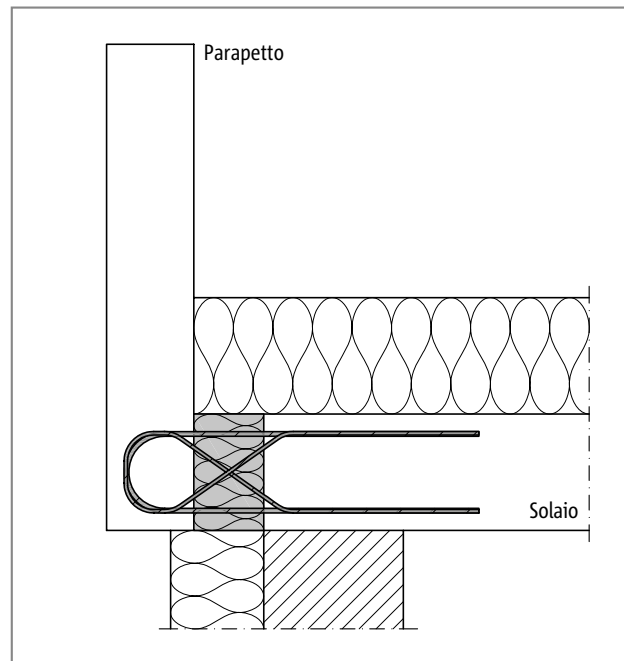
Schöck Isokorb® tipo ABXT - disposizione orizzontale, parapetto anteposto
